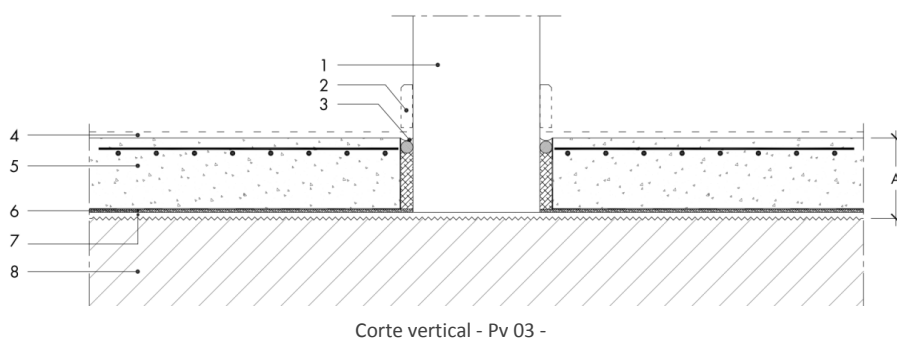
Esquema conceptual do pavimento do rés-do-chão. Adaptado de [30].
